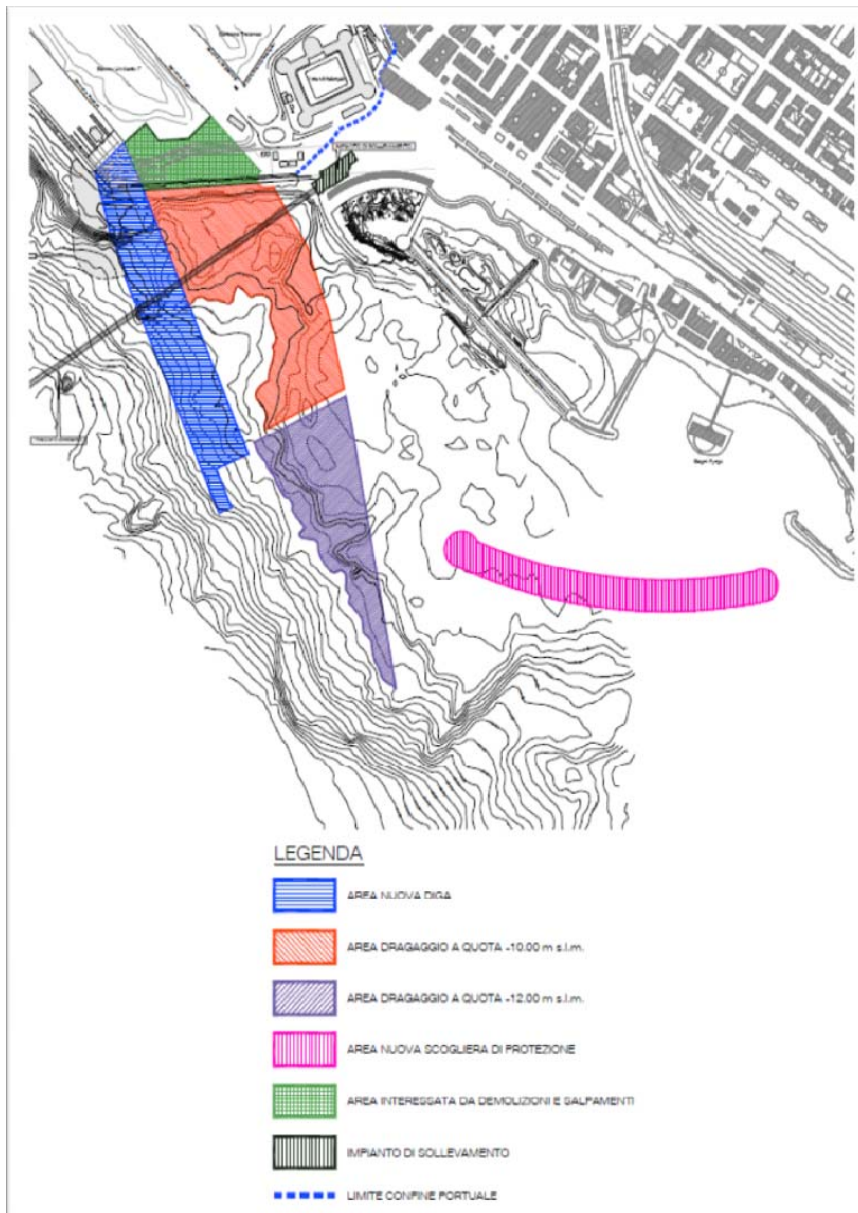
Planimetria generale degli interventi per il II Lotto funzionale delle Opere Strategiche.
